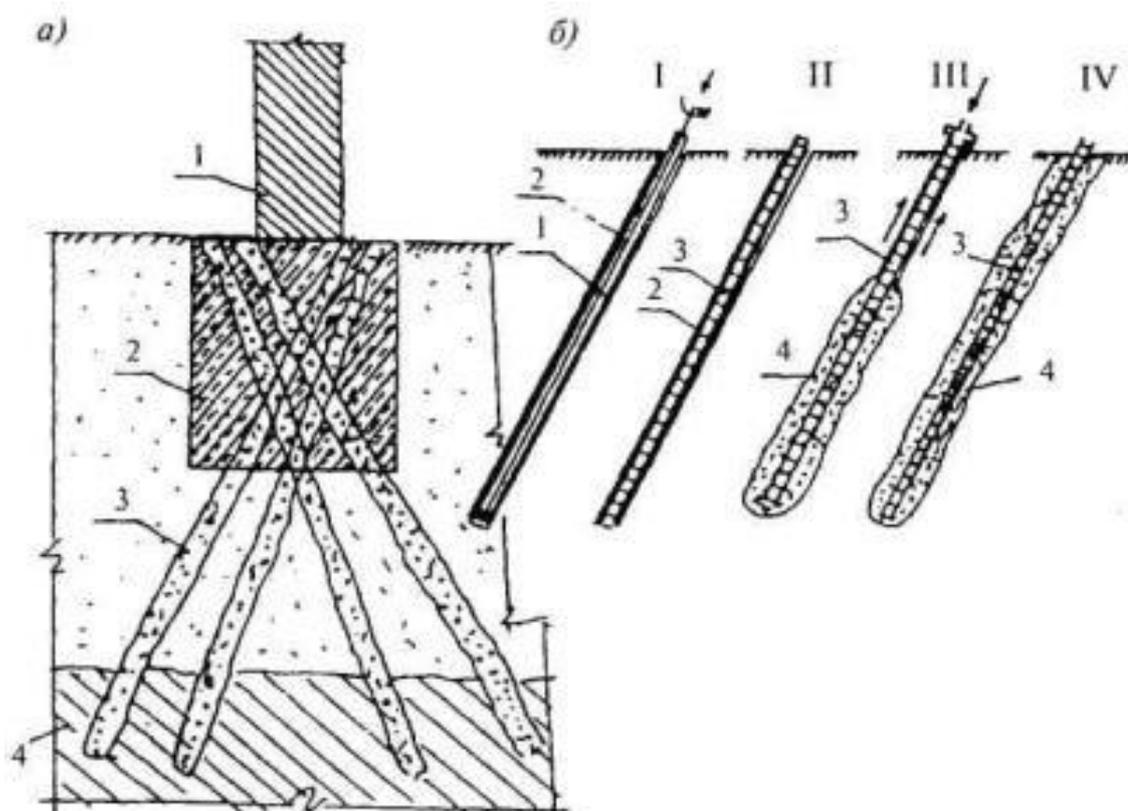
Схема усиления фундаментов: а - корневидными сваями:
